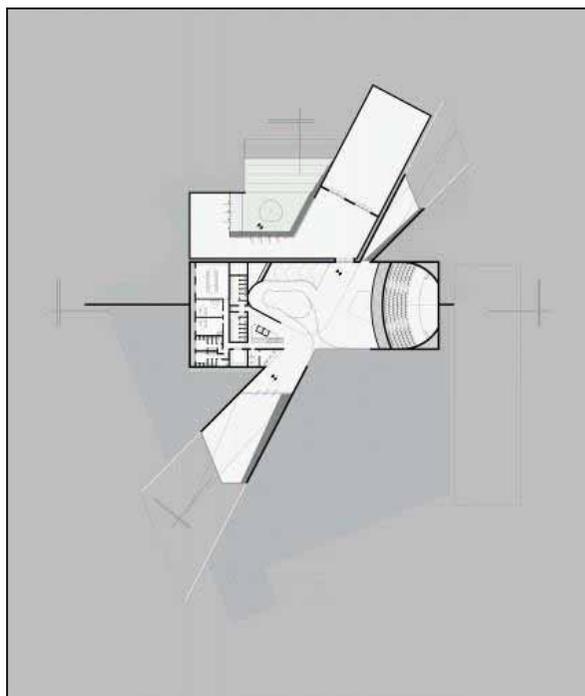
Planta Baixa- Térreo. Fonte: <http://www.archdaily.com>
